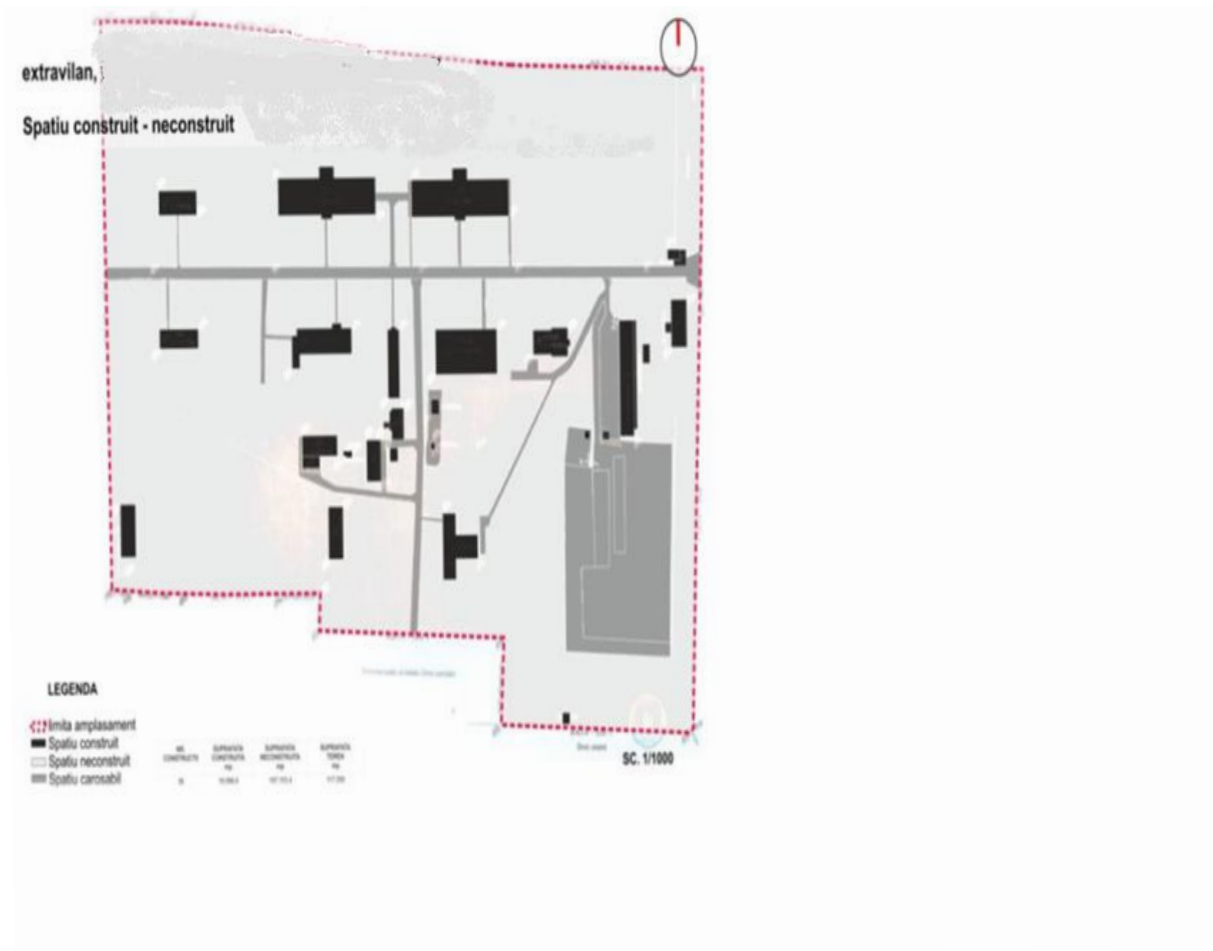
Imobile C1-C26, nr. cadastral 250- Spațiu construit-neconstruit
